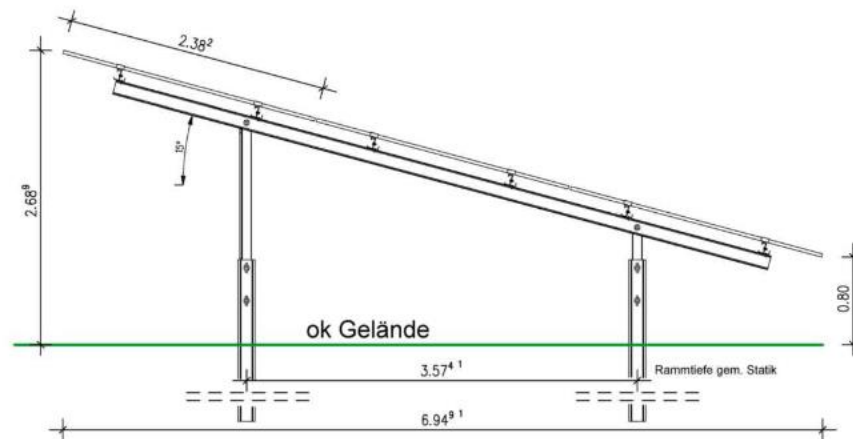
Technische Zeichnung - Quelle: Auftraggeber
